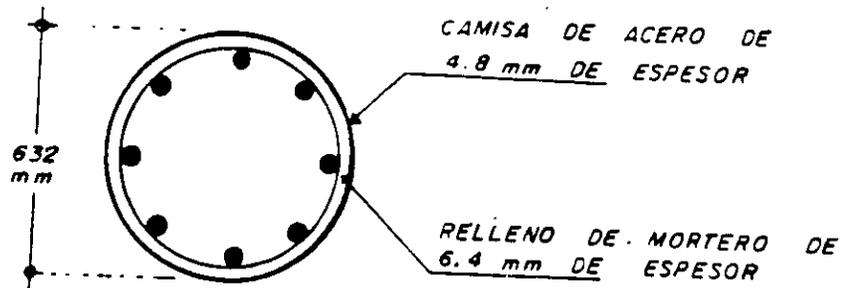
Sección de una columna circular rehabilitada con una camisa delgada de acero, circular.
